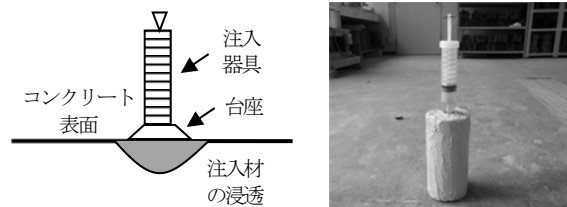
シラン低圧注入による微細ひび割れ検査法の概要図
